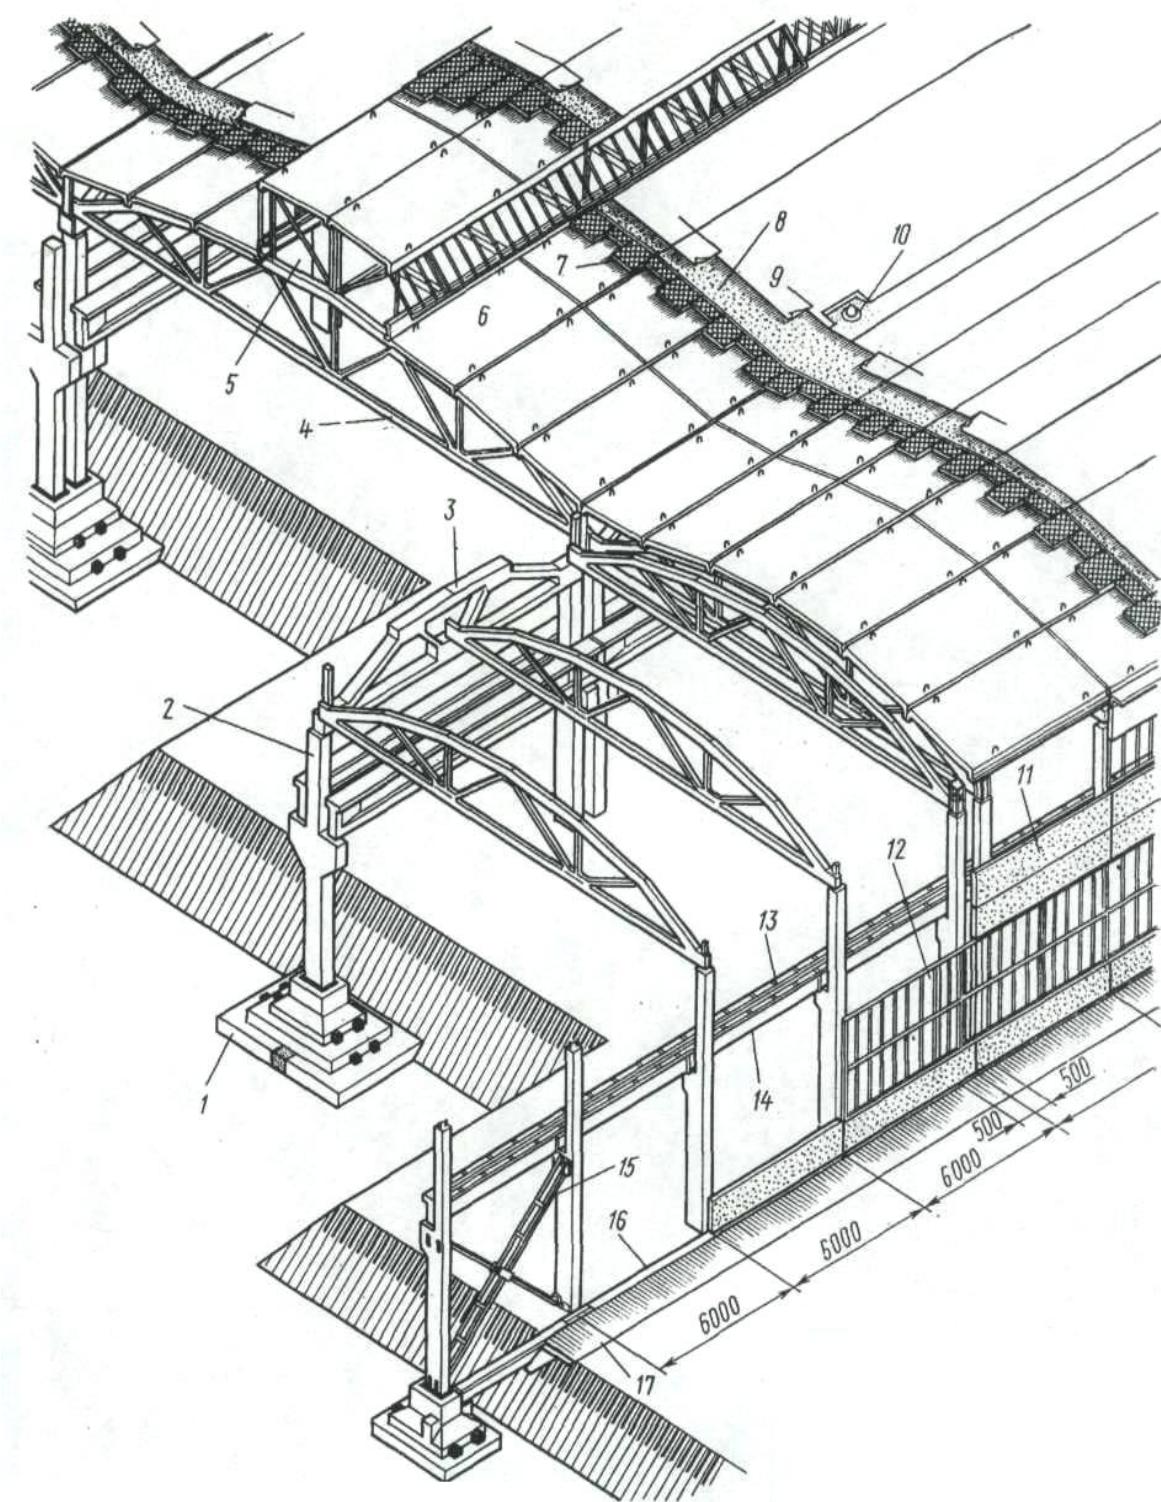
Залізобетонний каркас одноповерхової будівлі:
